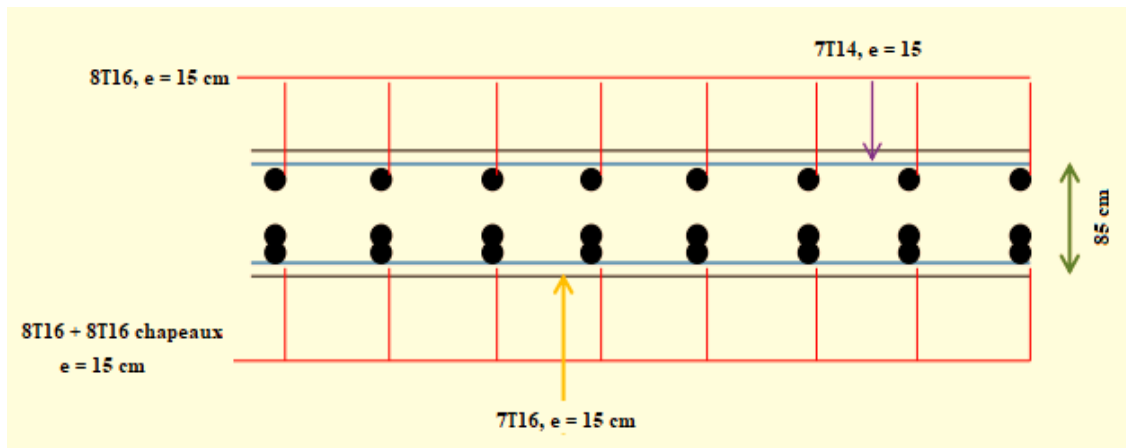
Ferrailage de la dalle du radier pour une bande de 1m sens Y-Y.
